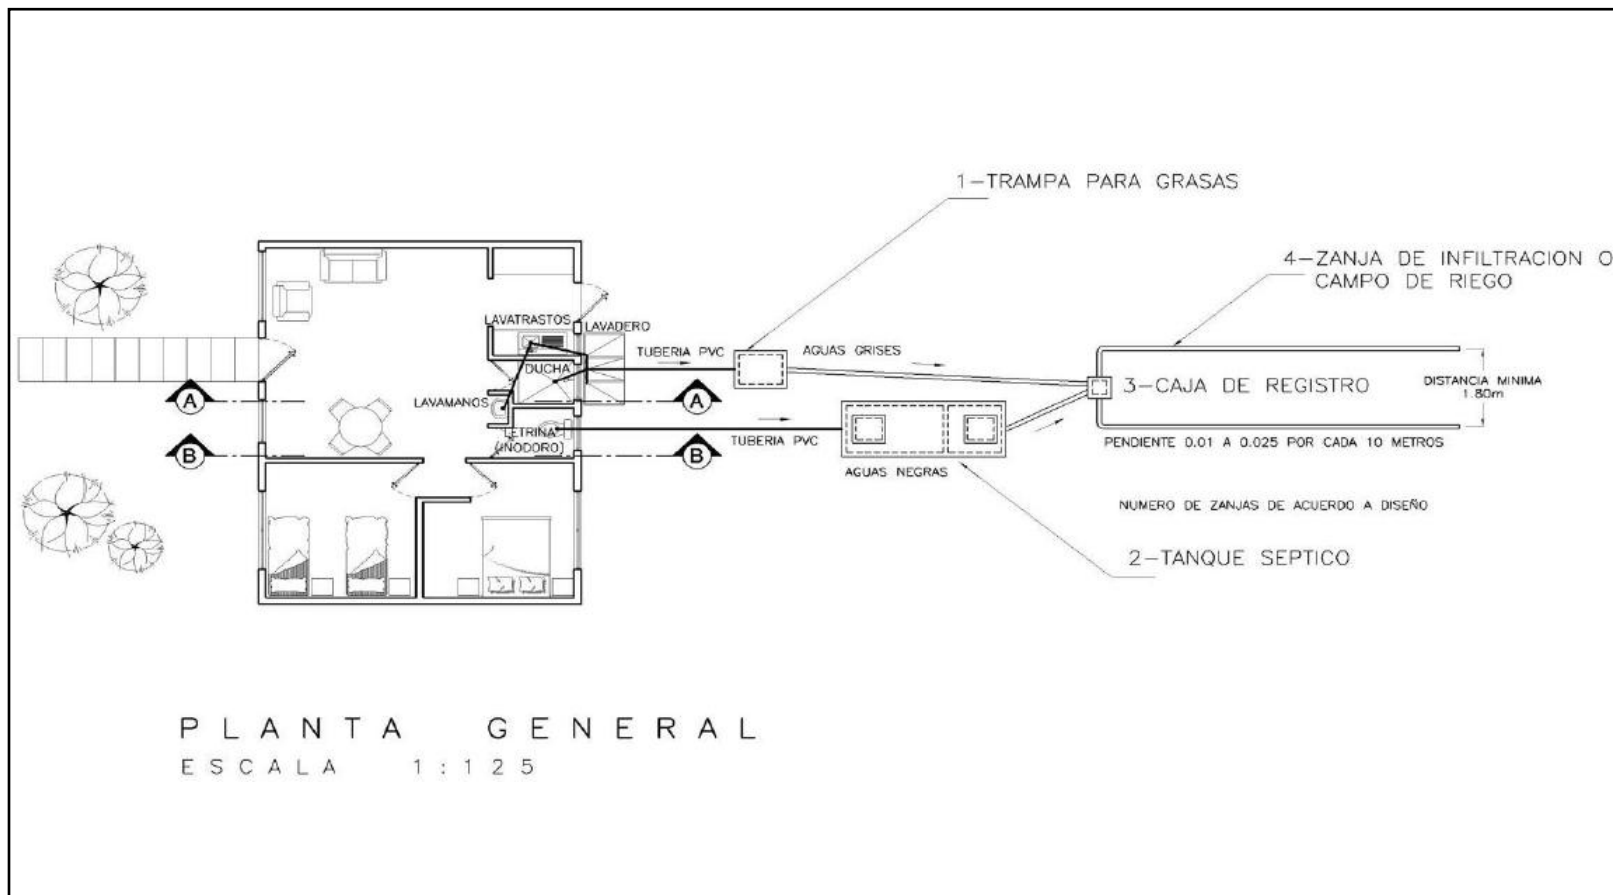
Vista en planta de sistema de fosa séptica, trampa de grasas y zanjas de infiltración.
